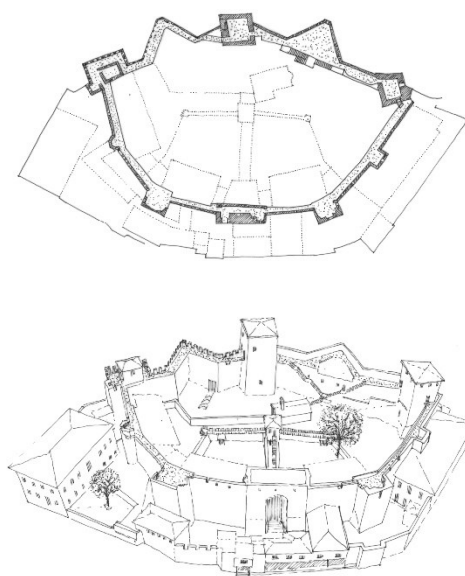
Eptapyrgio*, Salonicco. Il cammino di ronda, planimetria complessiva, vista generale e particolare fronte est
